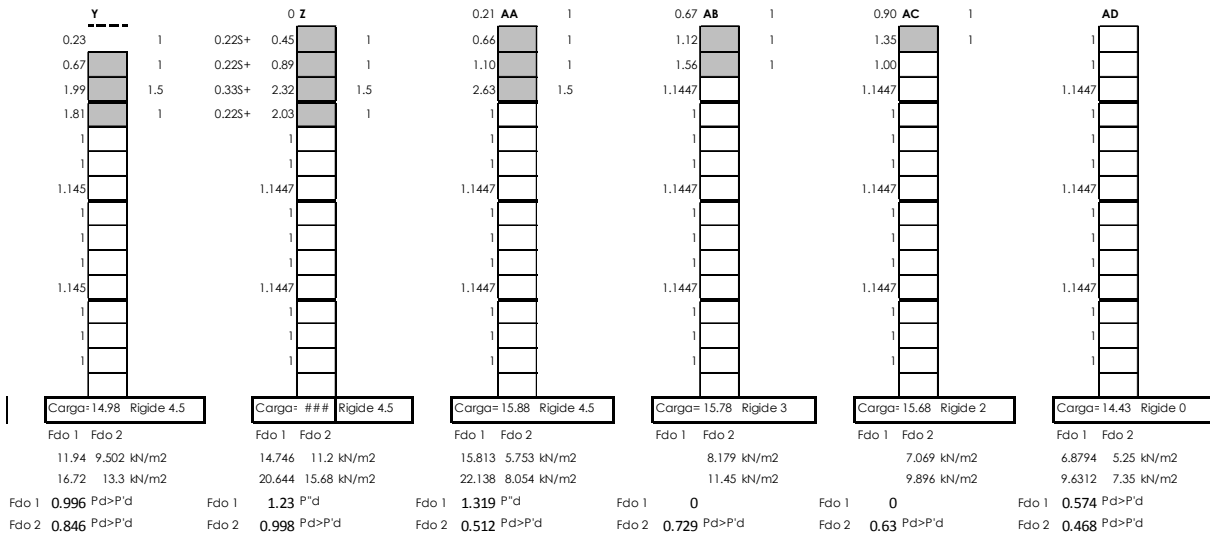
Proceso Constructivo. \$ cimbras 3 forjados de sacrificio. Losa Maciza. 5/5
